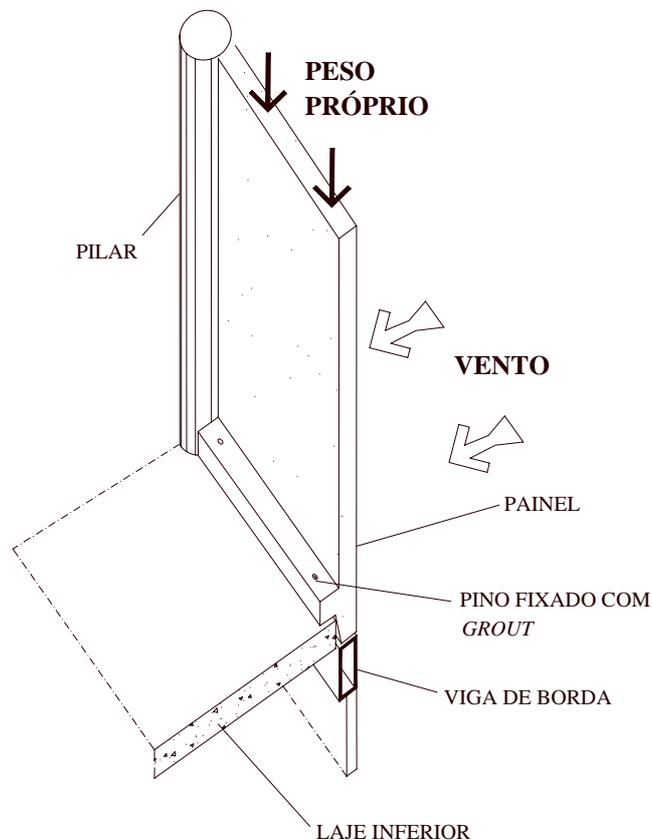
Perspectiva de um painel de concreto utilizado como vedação, com fixação na laje e na viga.
